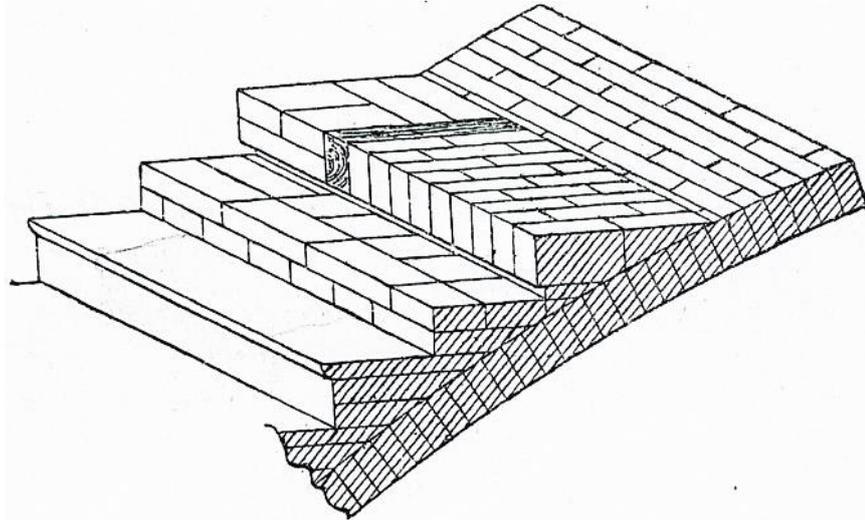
Лестница на кирпичном своде с деревянной пробкой для монтажа проступей. В.Р. Бернгард, 1903 г. [7]
